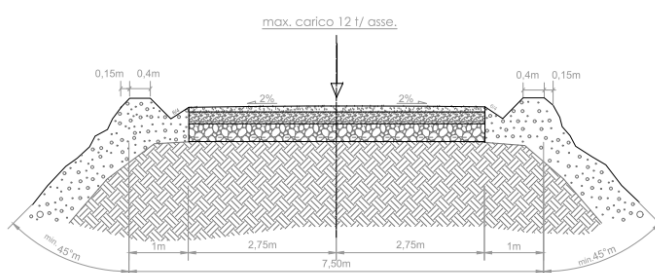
Sezione stradale tipo a doppia scarpata (in rilevato)
